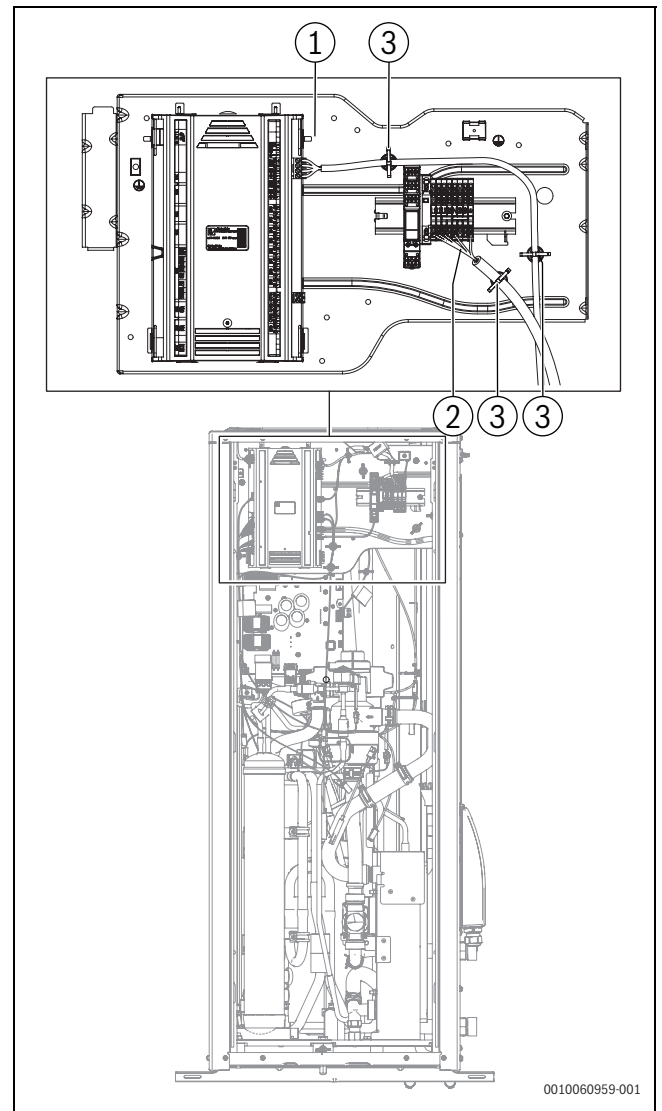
Bornes de raccordement dans la zone de raccordement de l'installation (O-T)
